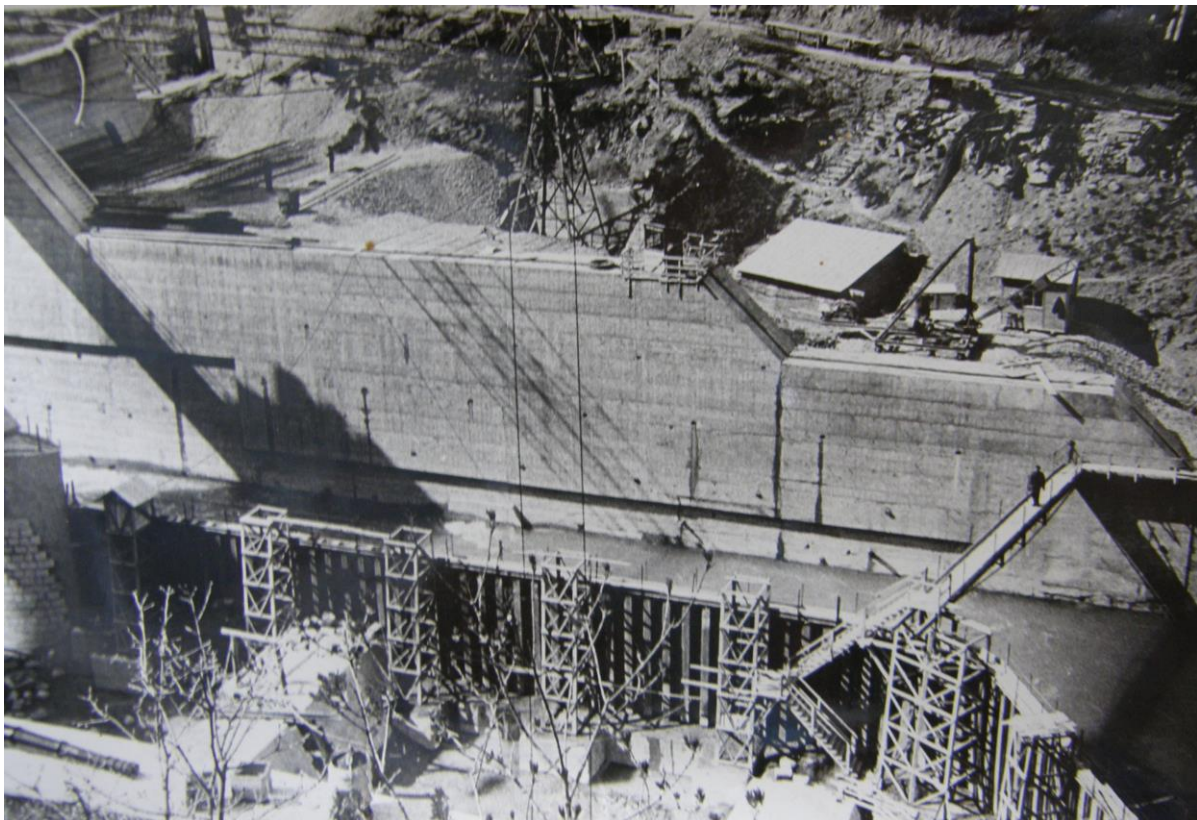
Muro d'ala – si osservano tracce di funzionamento dei drenaggi.
